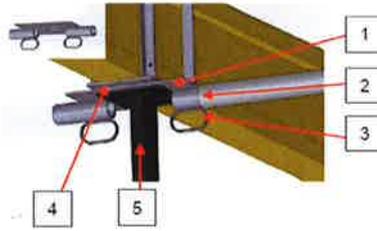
Durchsturzsicherungen für Deckenschalungen, Typ: Hammock Safety System, Typen: A1, A2, B1 und B2
